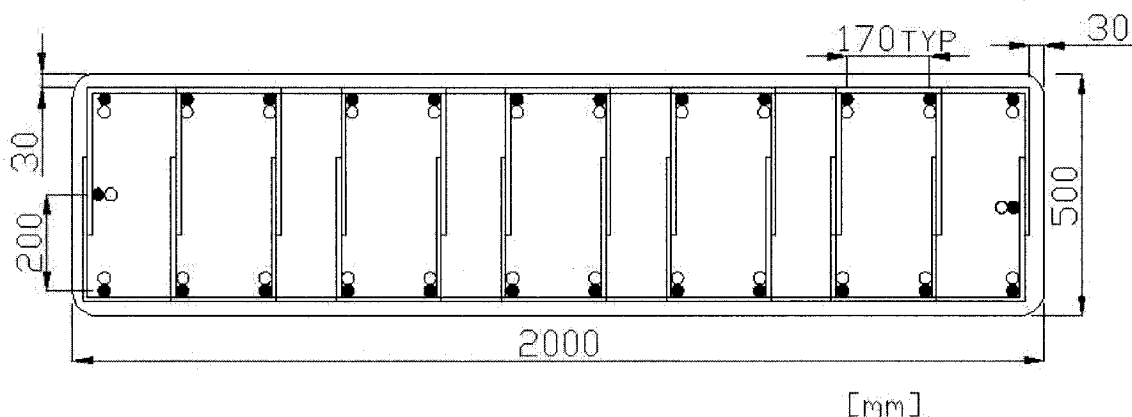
Coupe transversale du pilier dans la zone de chevauchement
